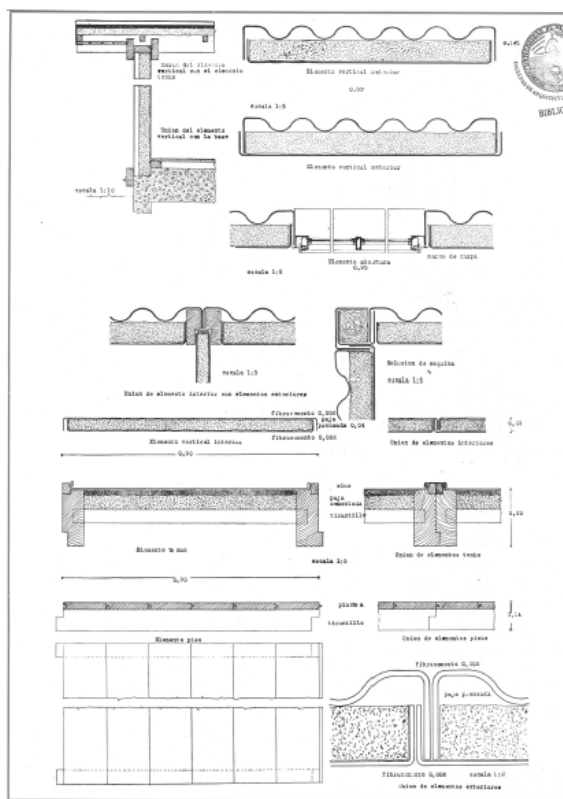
Elementos prefabricados para la construcción de viviendas rurales. Grupo Austral, 1939. Fuente: 2 *Austral*, en *Nuestra Arquitectura*, no. 122, 9/1939.
